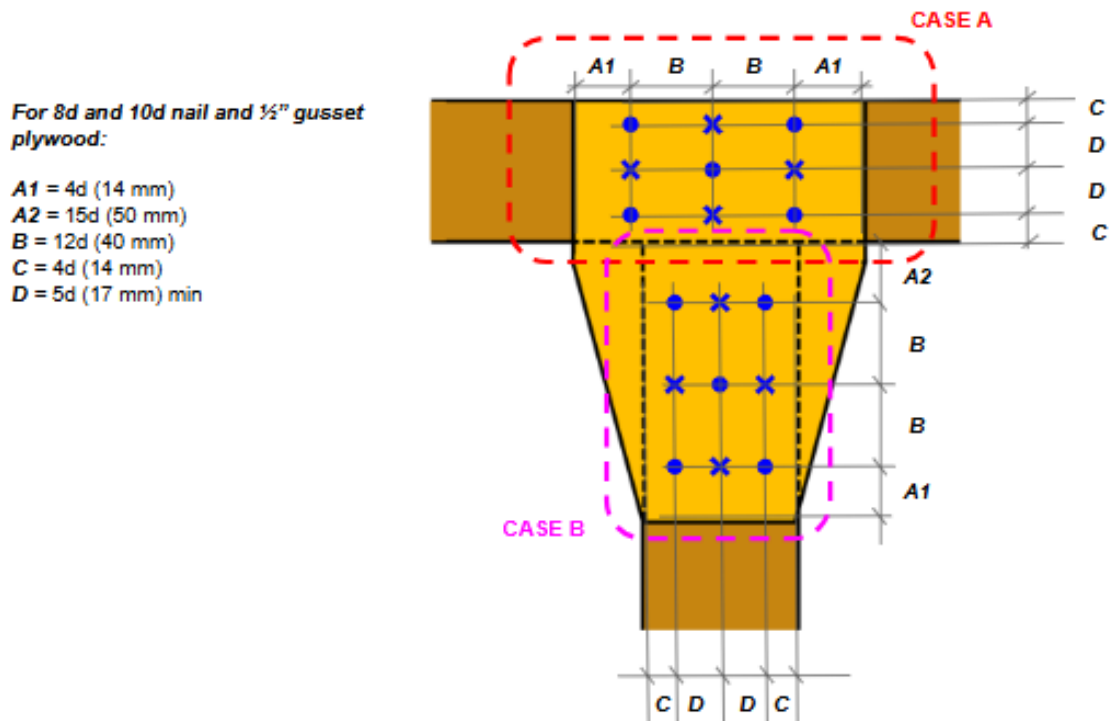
Extrait du tableau 1.5.6.9.9-3
